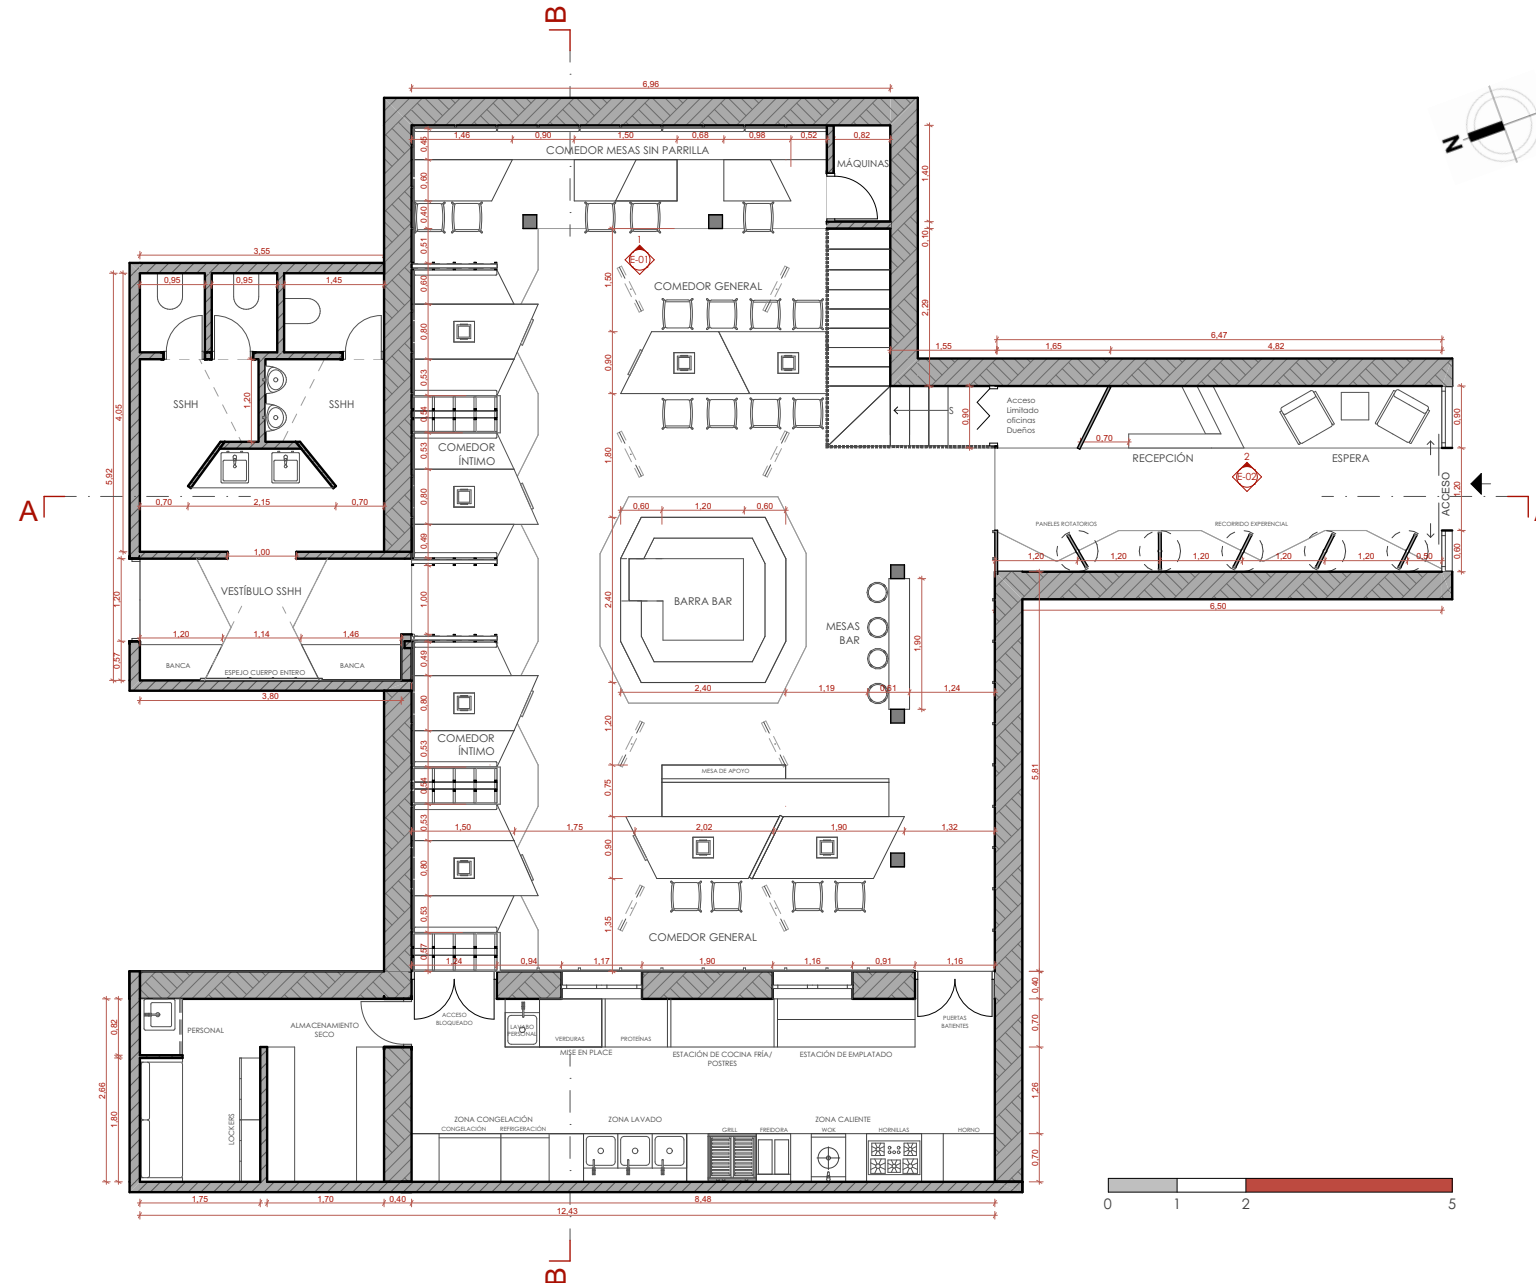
Planta Amoblada. Fuente: Elaboración Propia
